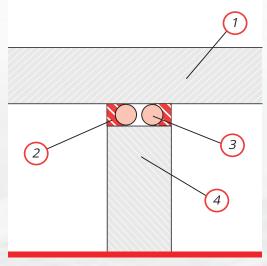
Schnitt Wand-/ Deckenfuge Fugenbreite ≤ 40 mm
